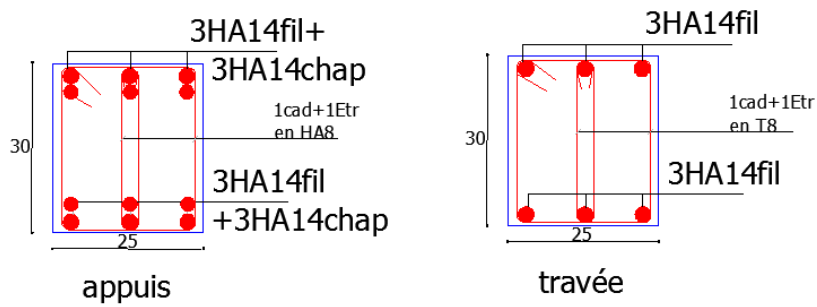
schéma de ferrailage des poutres secondaire adhérent au voiles
